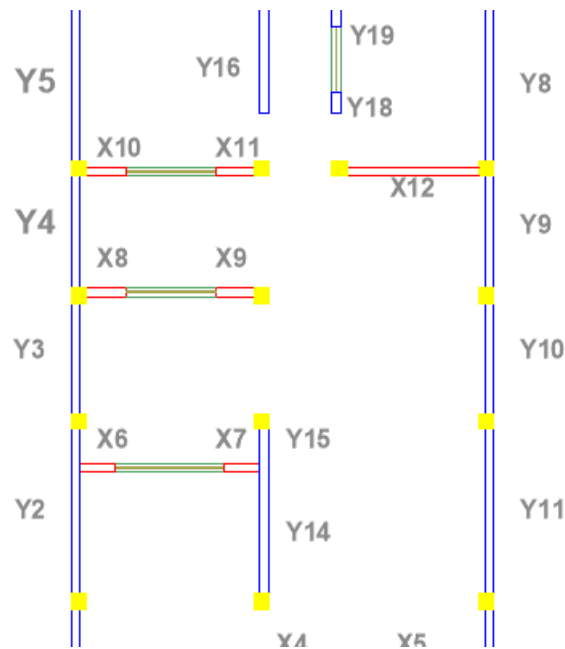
PLANTA DE DISTRIBUCION DE MUROS
